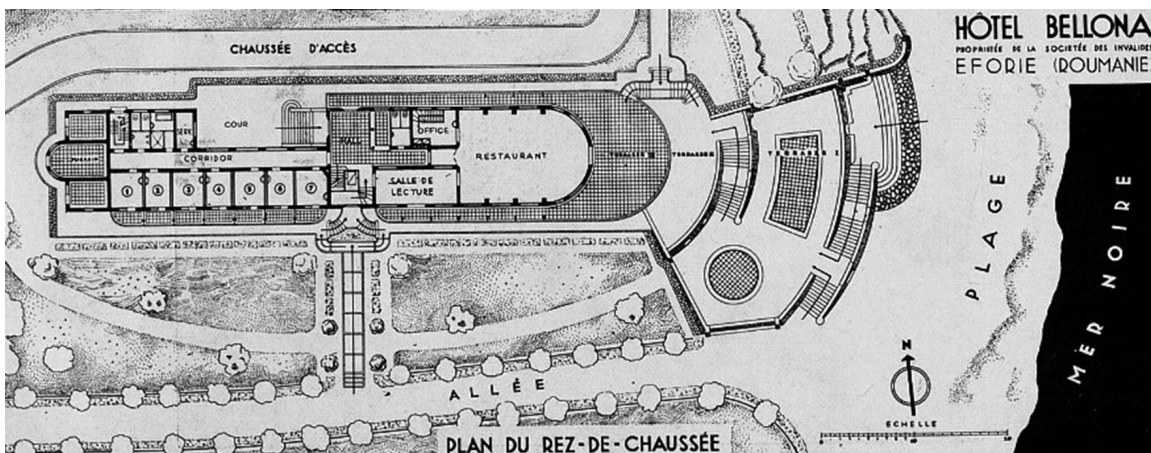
Eforie Nord, hotelul Bellona, proprietatea Societății Invalizilor de Război, construit după planurile lui G. M. Cantacuzino - planul parterului (după G. M. Cantacuzino, *Une plage sur la mer Noire*, 1934).
